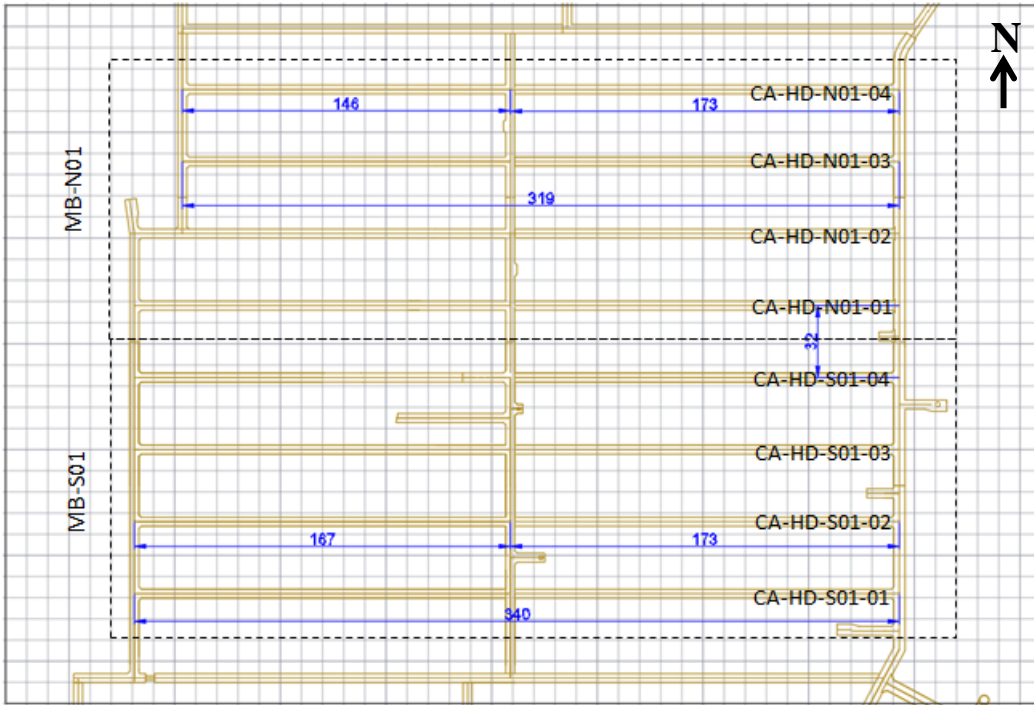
Vista en planta subnivel de hundimiento MB centrales
